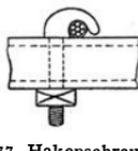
Hakenschraube zur Befestigung des Luftkabel-Tragseils an Querträgern.
